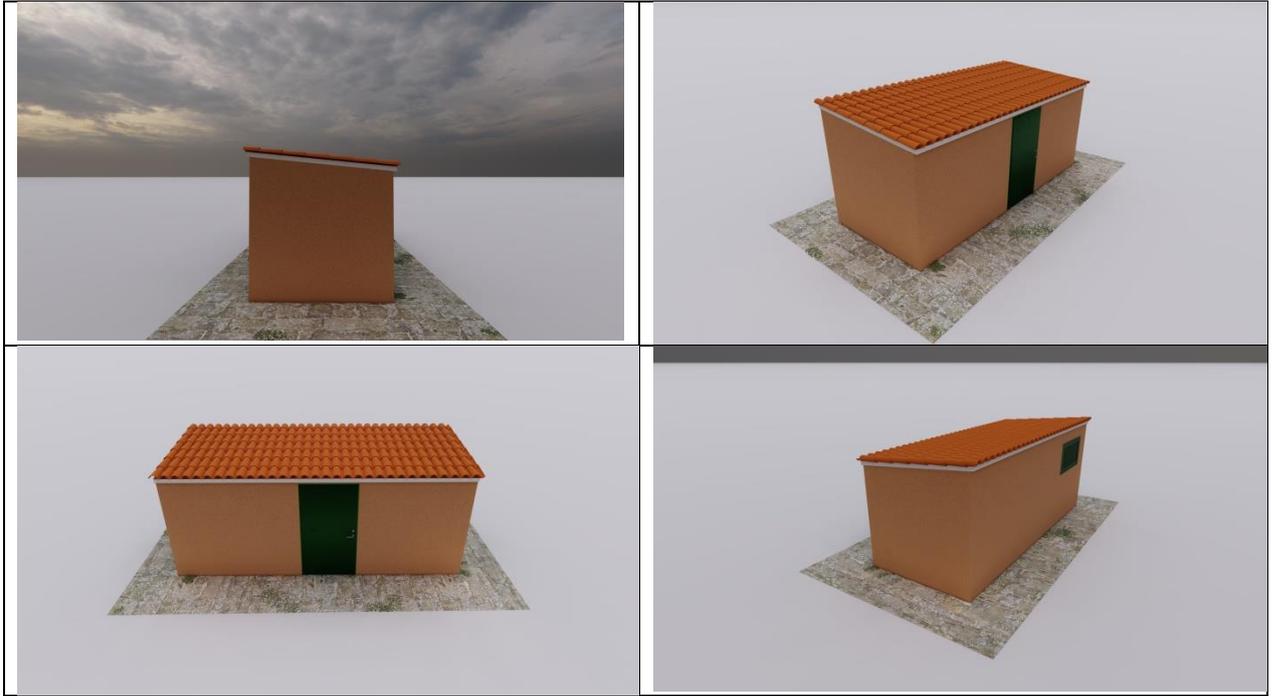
Detalle del CMM FV con acabado exterior tipo “embetumat” color ocre tierra y cubierta inclinada con teja árabe a un agua.
